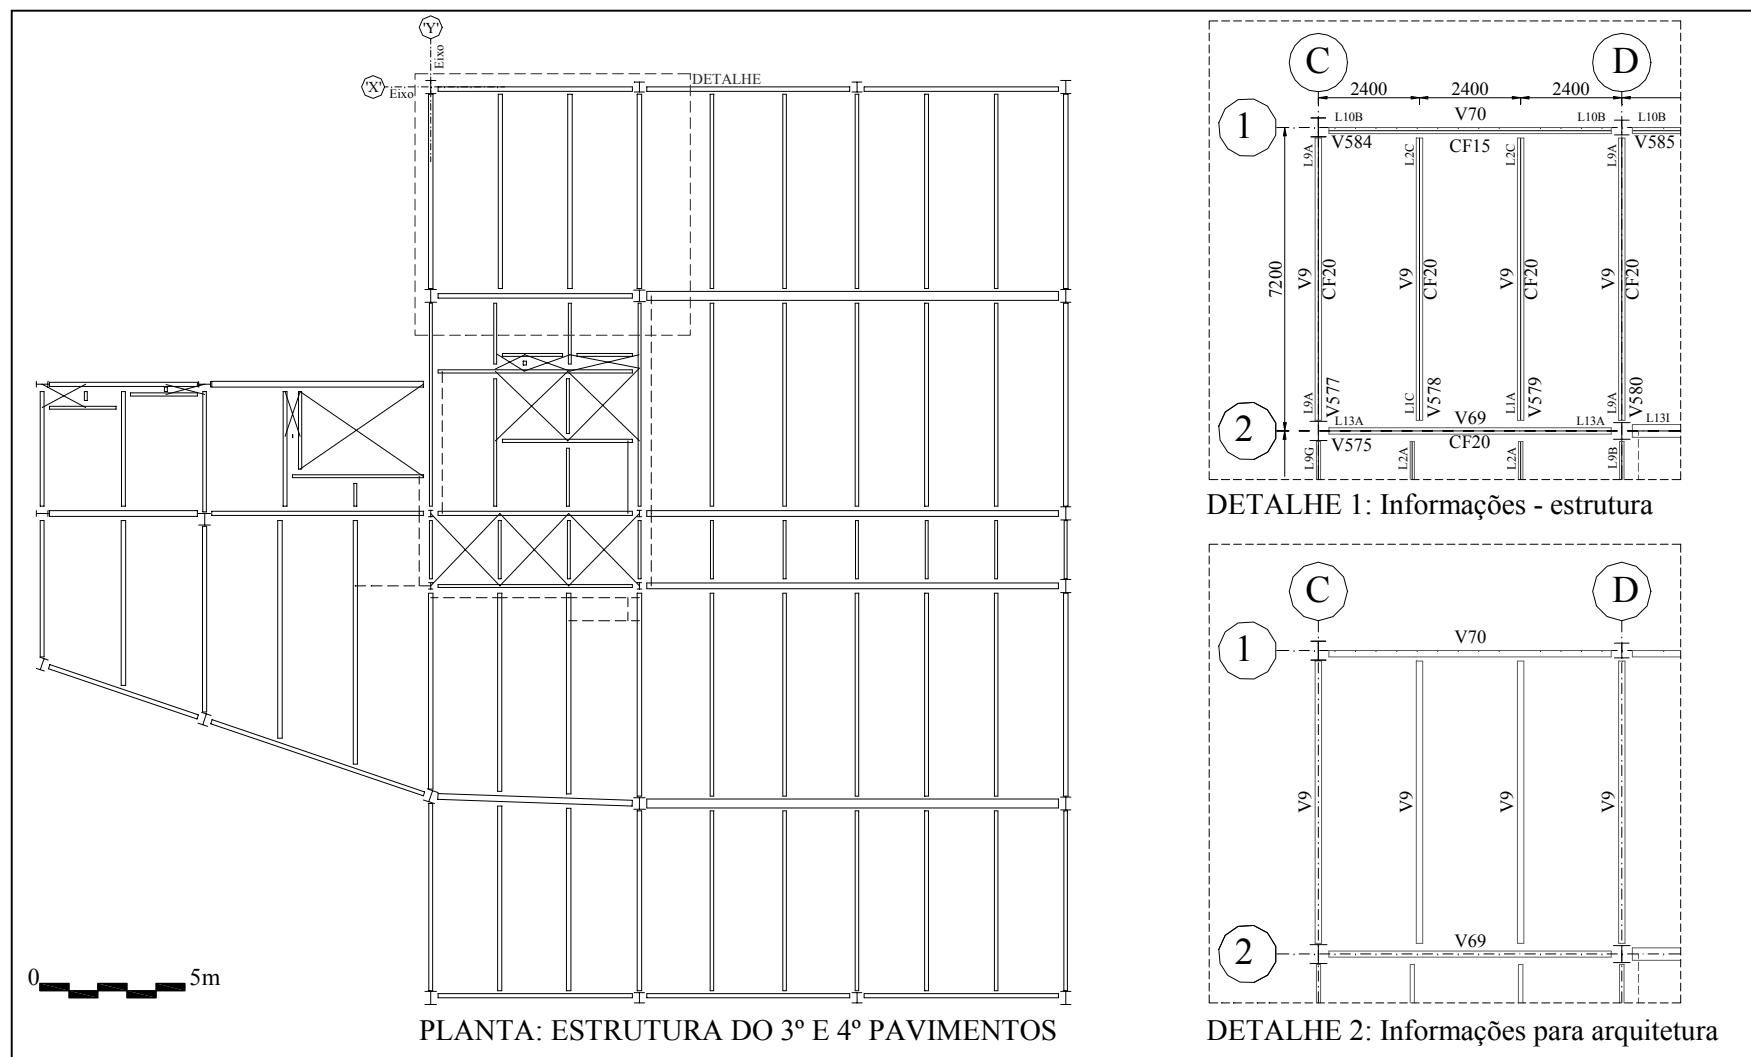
Solução estrutural do edifício E-4: esboço do *layout* dos pavimentos 3 e 4, forma de representação das informações no projeto estrutural e demonstração da possibilidade de isolamento das informações de interesse da arquitetura.
